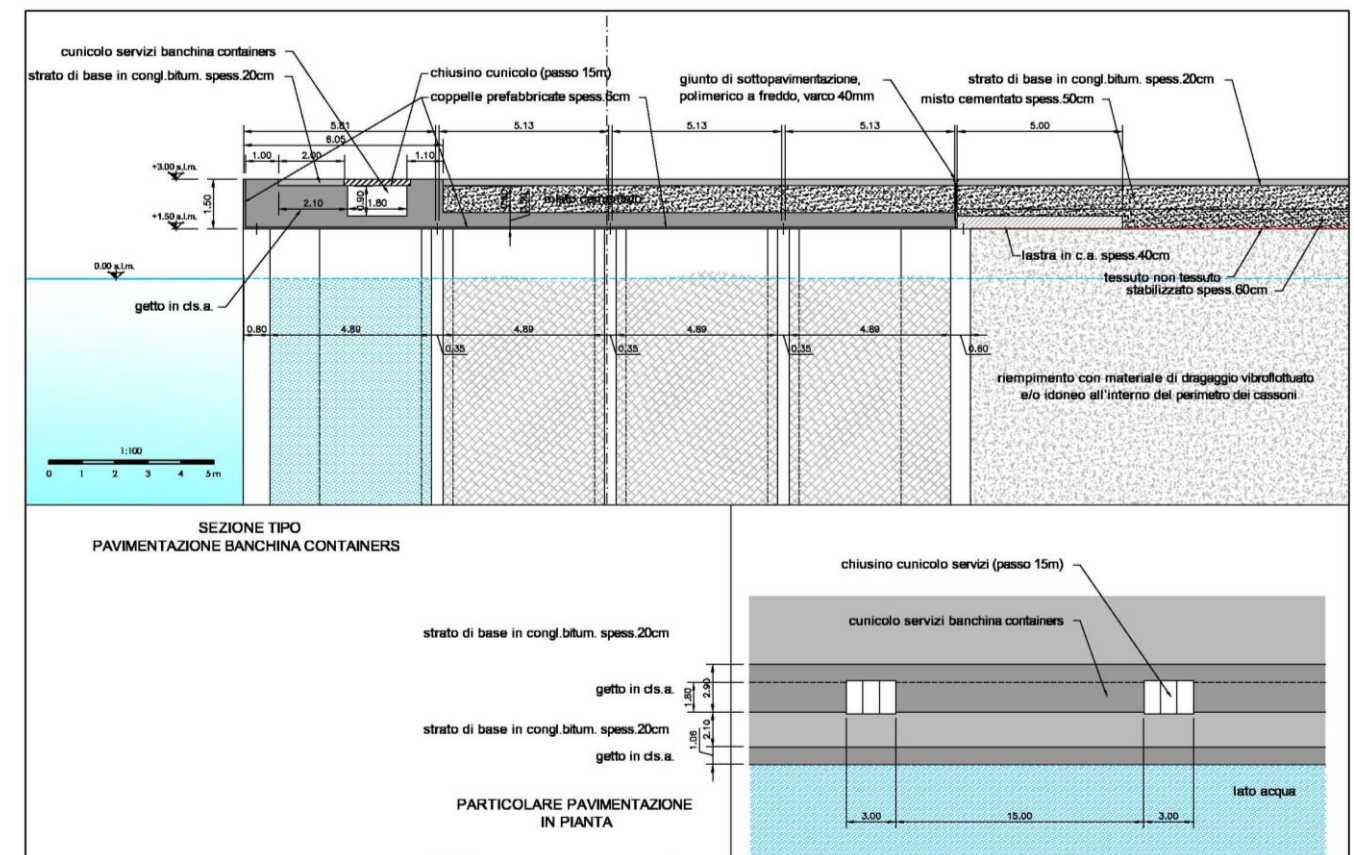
Banchina containers - sezione tipo delle pavimentazioni
